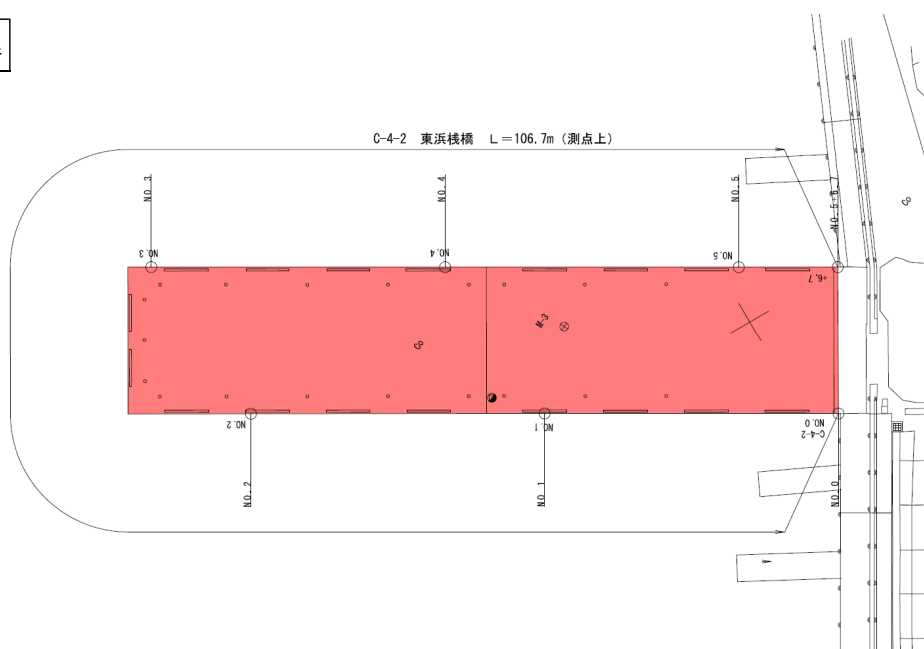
23 No.4 東浜栈橋の平面図（被災後）
